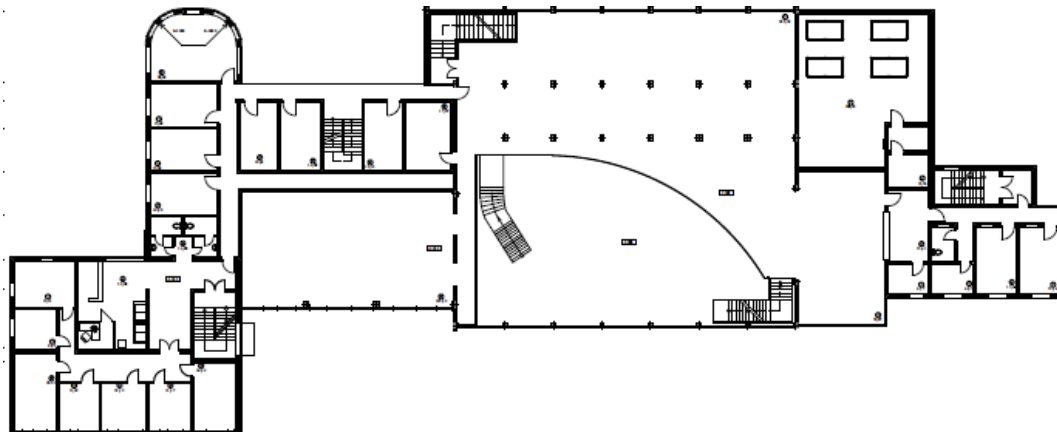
План 2-го этажа железнодорожного вокзала
